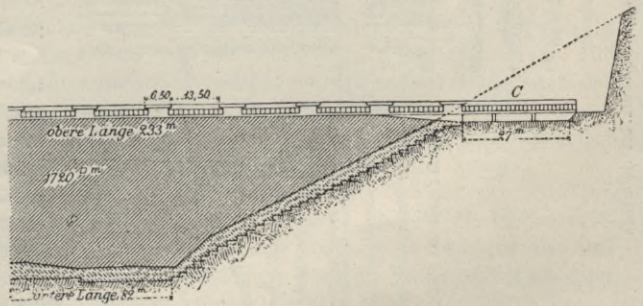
Gileppe Talsperre. Schnitt durch die Mauer mit Überlauf und Kaskade. 1:2000.
